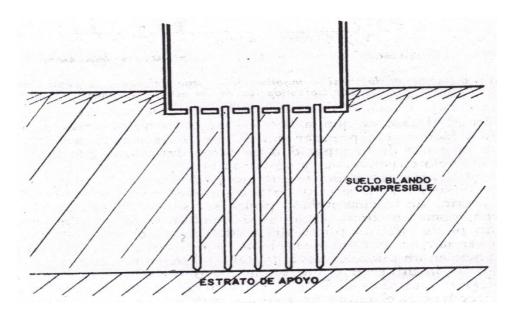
Pilotes atravesando libremente la cimentación.
